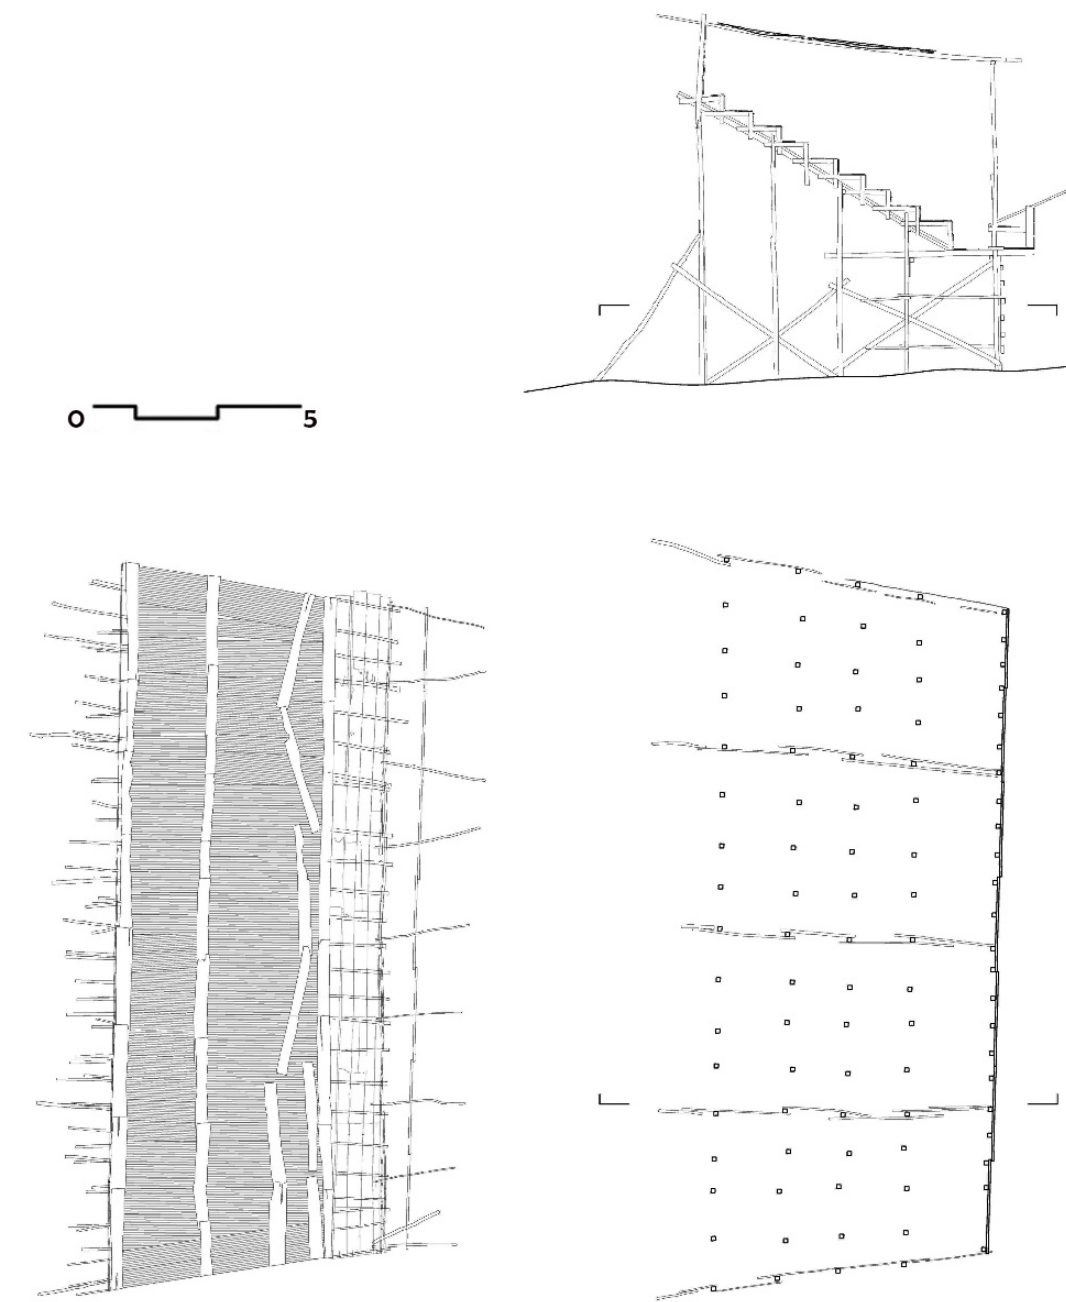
Sección y planos. Reconstrucción gráfica mediante levantamiento escáner láser. La Corraleja de Cereté en 2019. Elaboraciones realizadas por los Autores. [2023]
